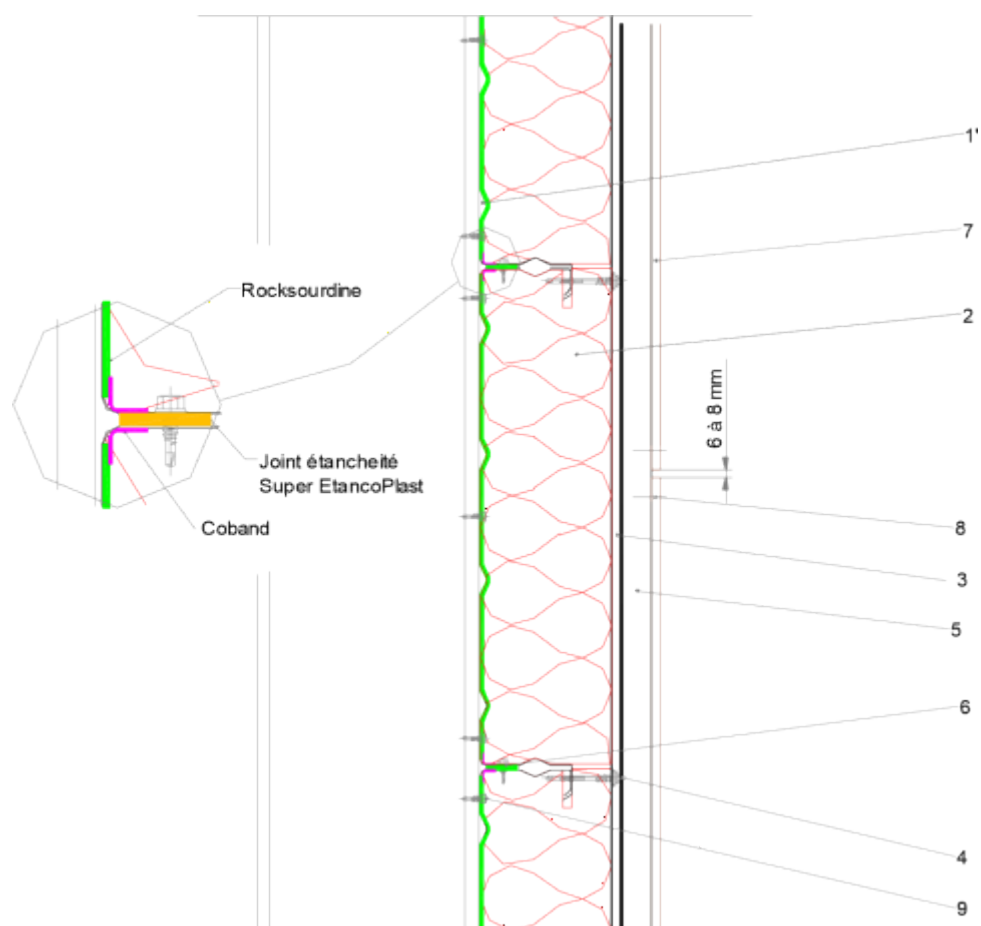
Coupe verticale en partie courante avec panneau EQUITONE (avec Rocksourdine sur plateaux perforés)
